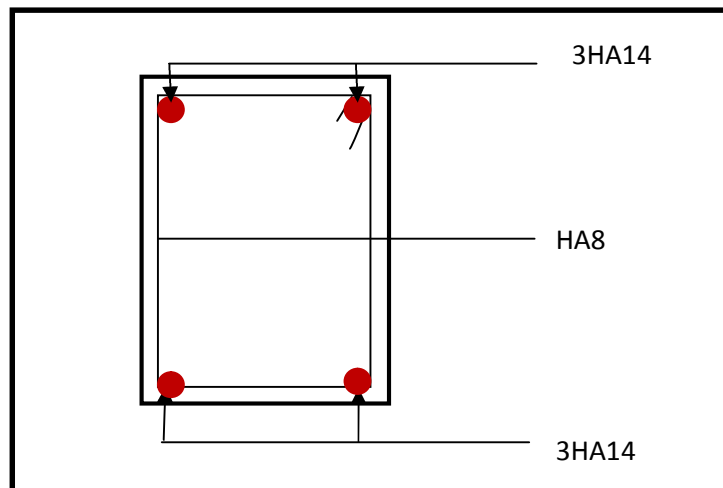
Figure.VI : Ferrailage sur appuis d'une poutre secondaire
